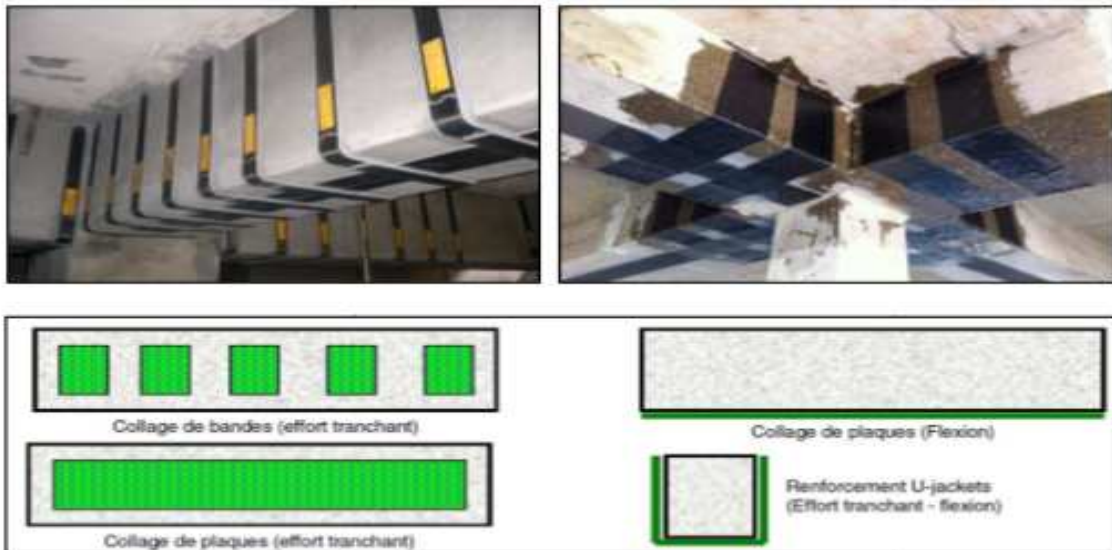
Différentes techniques de renforcement des poutres en béton armé. [24]
